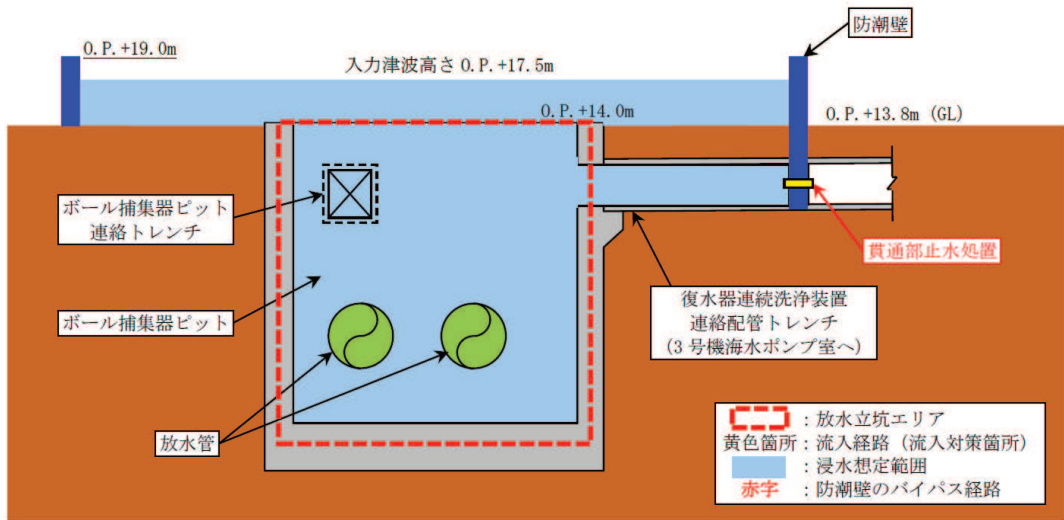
(17) 第 3 号機 放水立坑 流入対策配置図 (B-B 断面図)
